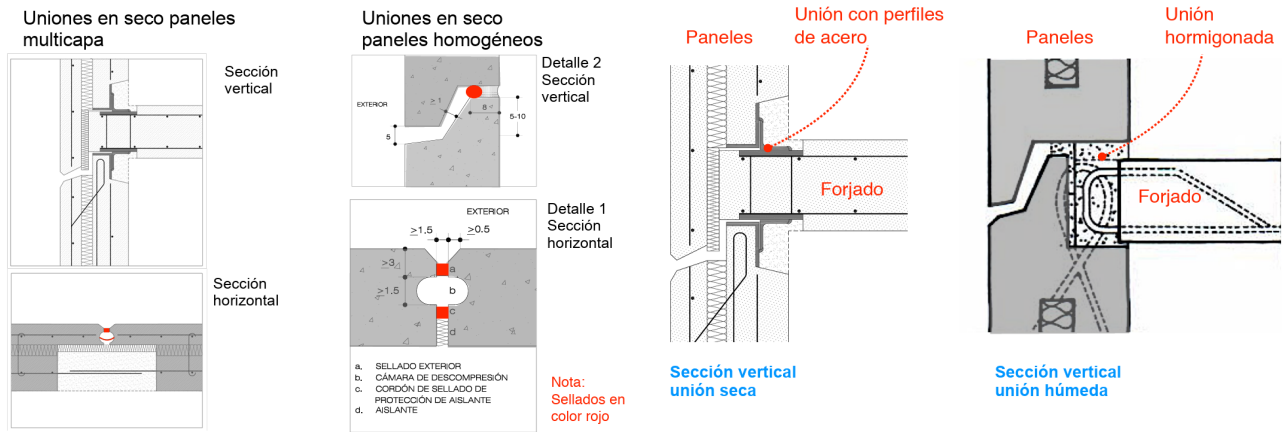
Junta de Paneles Prefabricados de Hormigón.
